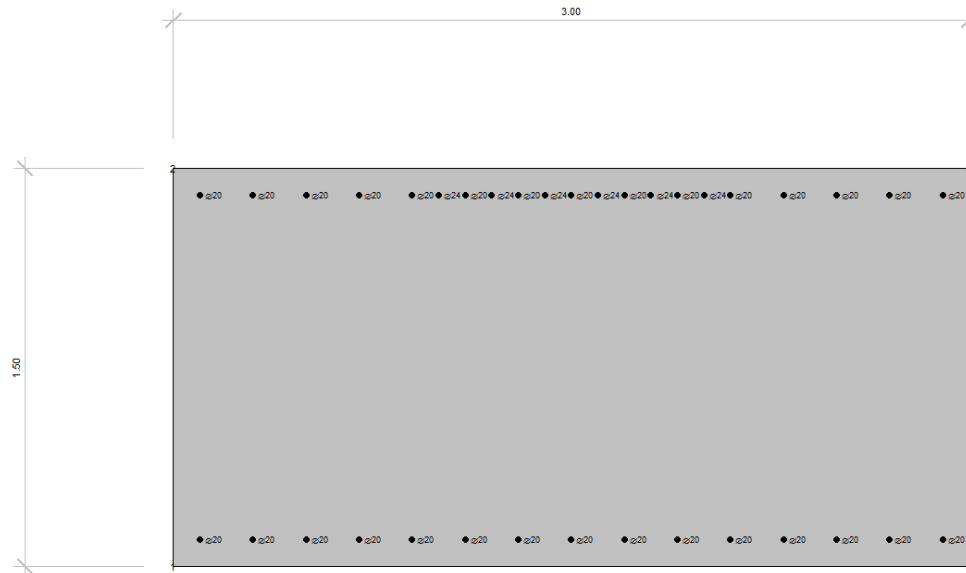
Platea di fondazione sotto al risvolto destro – Schematizzazione a elementi frame
